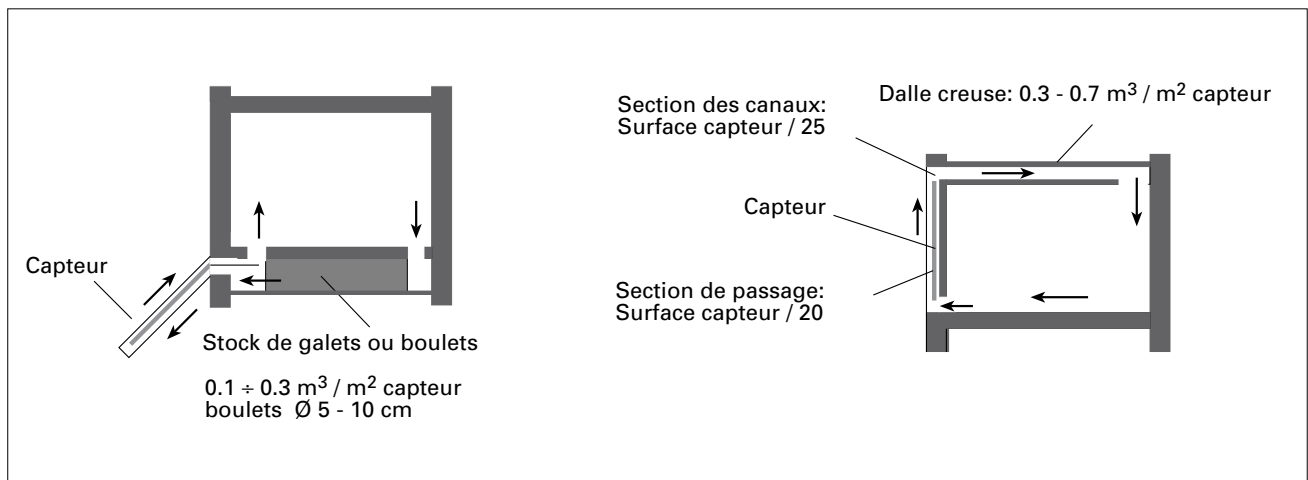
Stockage en lit de galets ou dalle creuse avec collecteurs à air en façade. Dimensionnement de base [4, 7, 13, 17].
